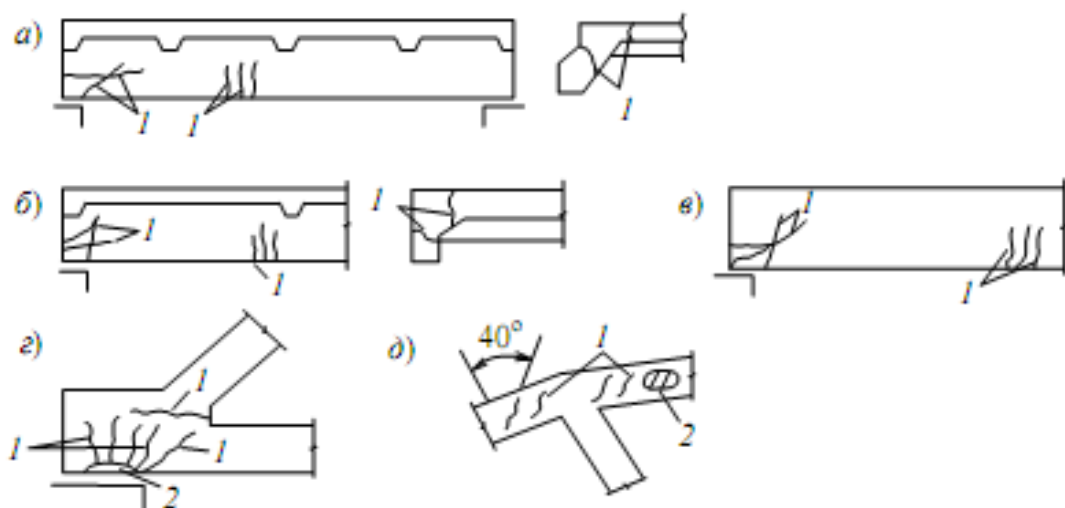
Схеми руйнування: а – плит ПКЖ; б – плит ПНС; в – напруженої розрізної балки; г – опорного вузла ферми; д – стиснутого вузла ферми: 1 – тріщини; 2 – відколи лещаток
